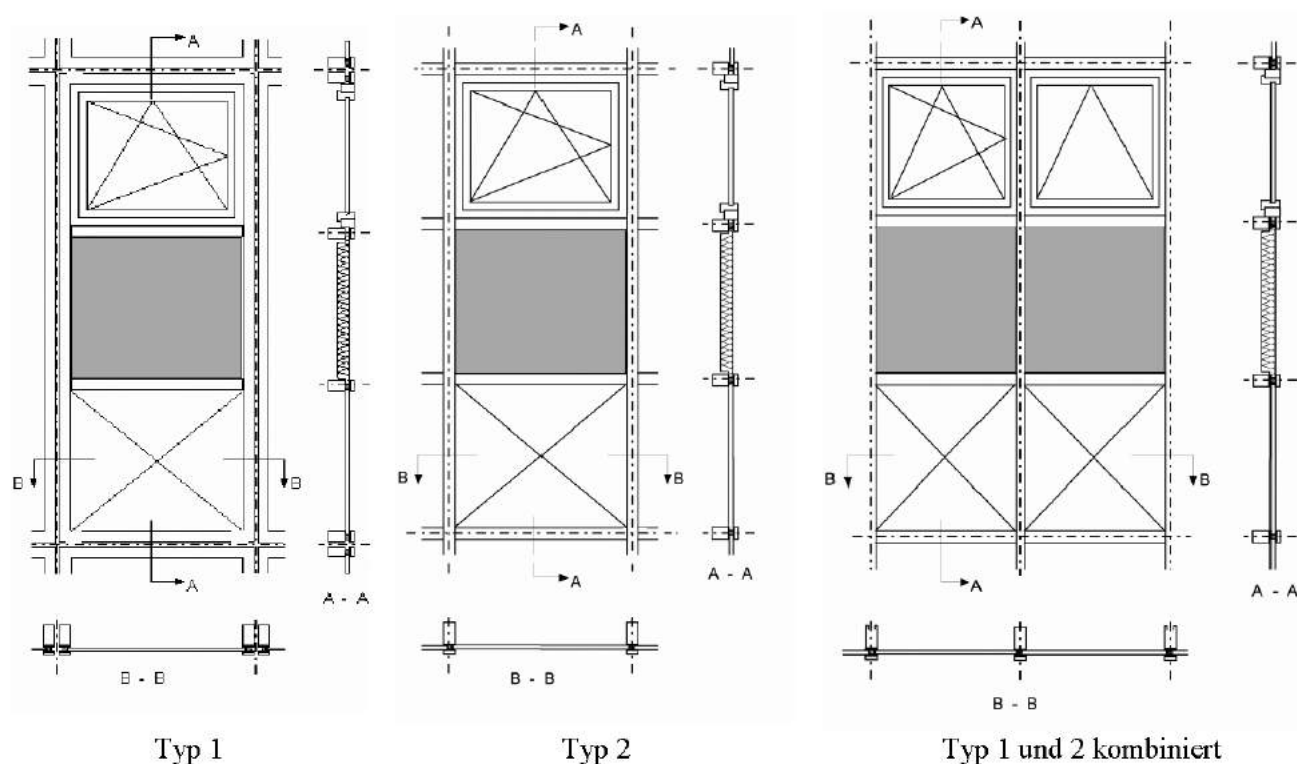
Abgrenzung der Flächen von Vorhangfassadenelementen
